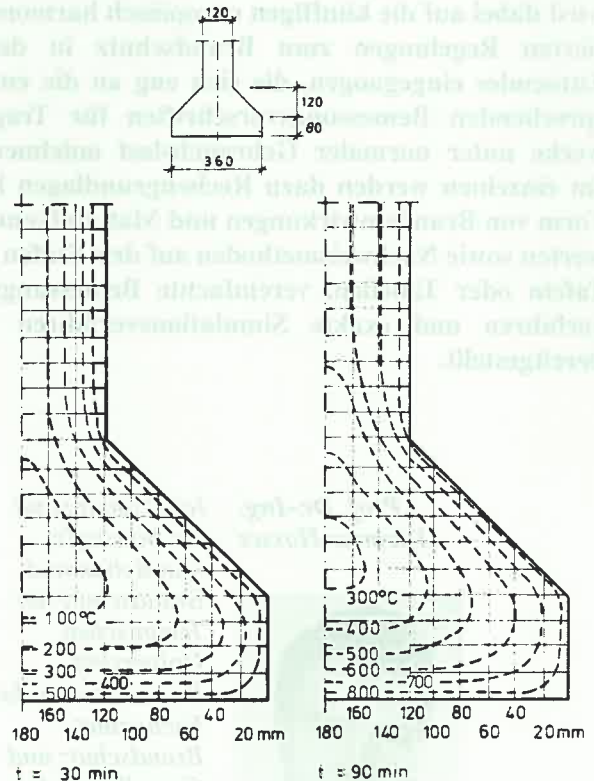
Isothermen $^\circ\text{C}$ in einem dreiseitig nach DIN 4102 Teil 2 (ETK) beanspruchten Stahlbetonbalken mit I-Querschnitt nach 30 bzw. 90 Minuten Branddauer
